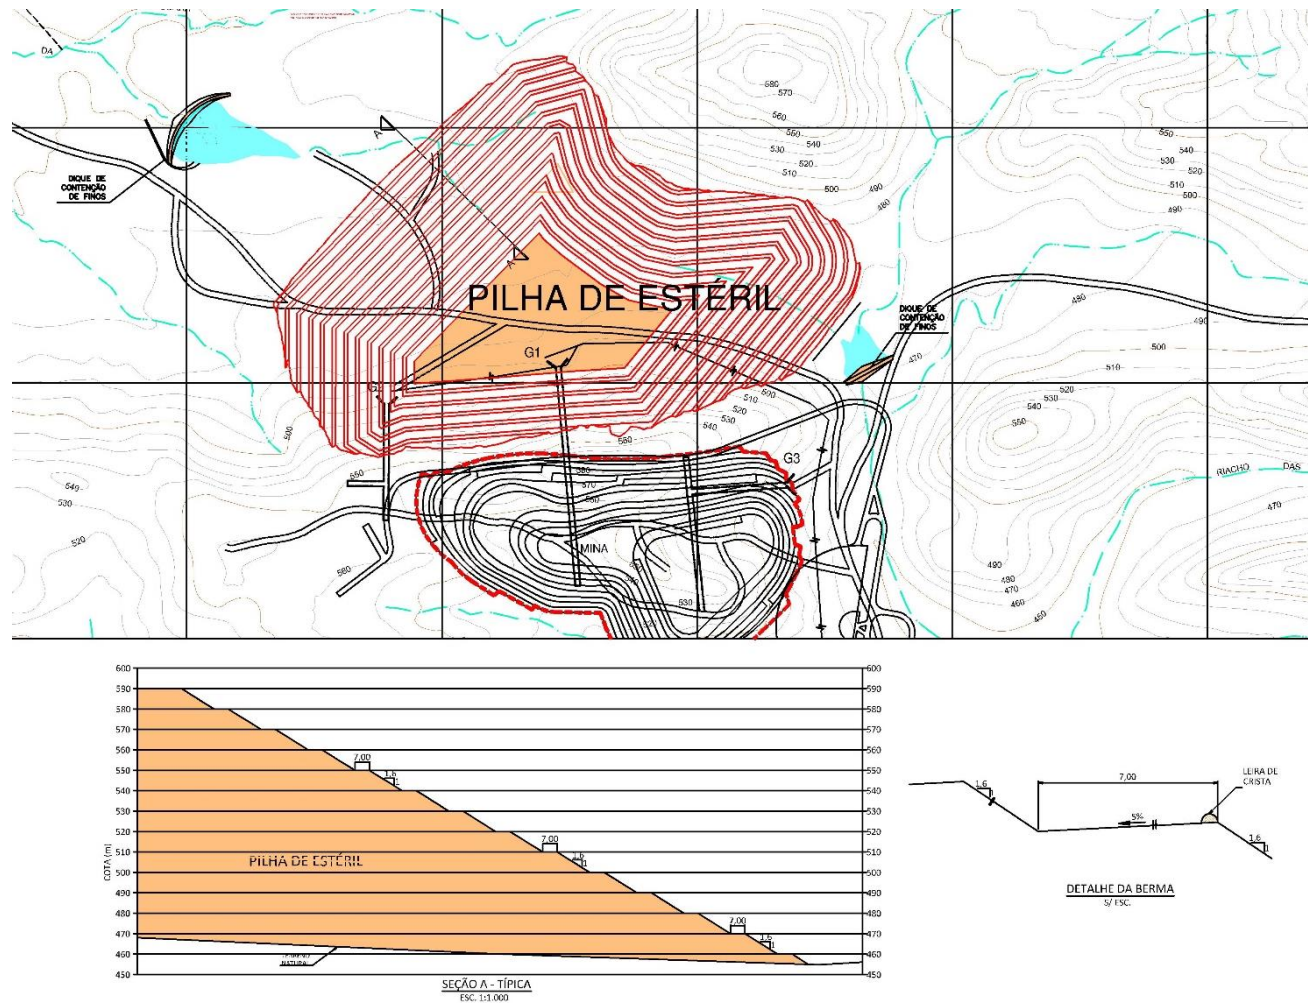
Pilha de Estéril - Planta e Seção Típica.
